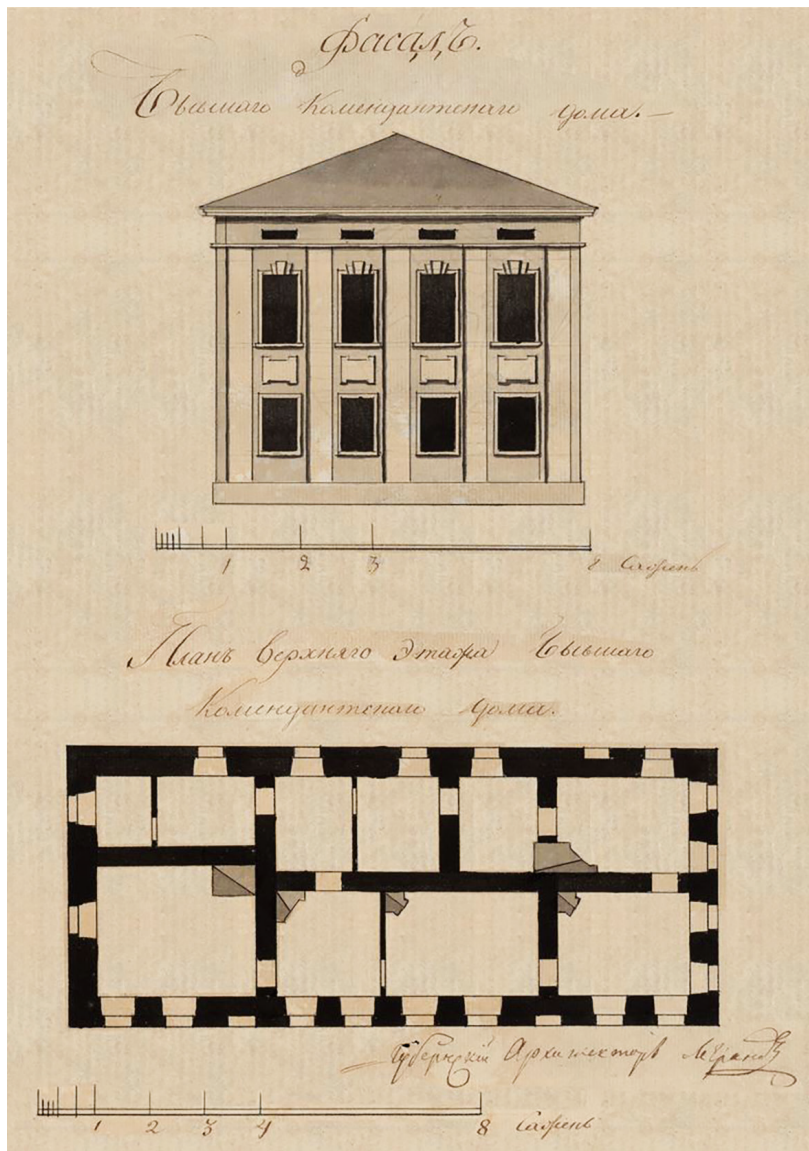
Тверь. Северный фасад и план нижнего этажа комендантского дома. Чертеж 1820-х годов [XVIII, л. 1]
